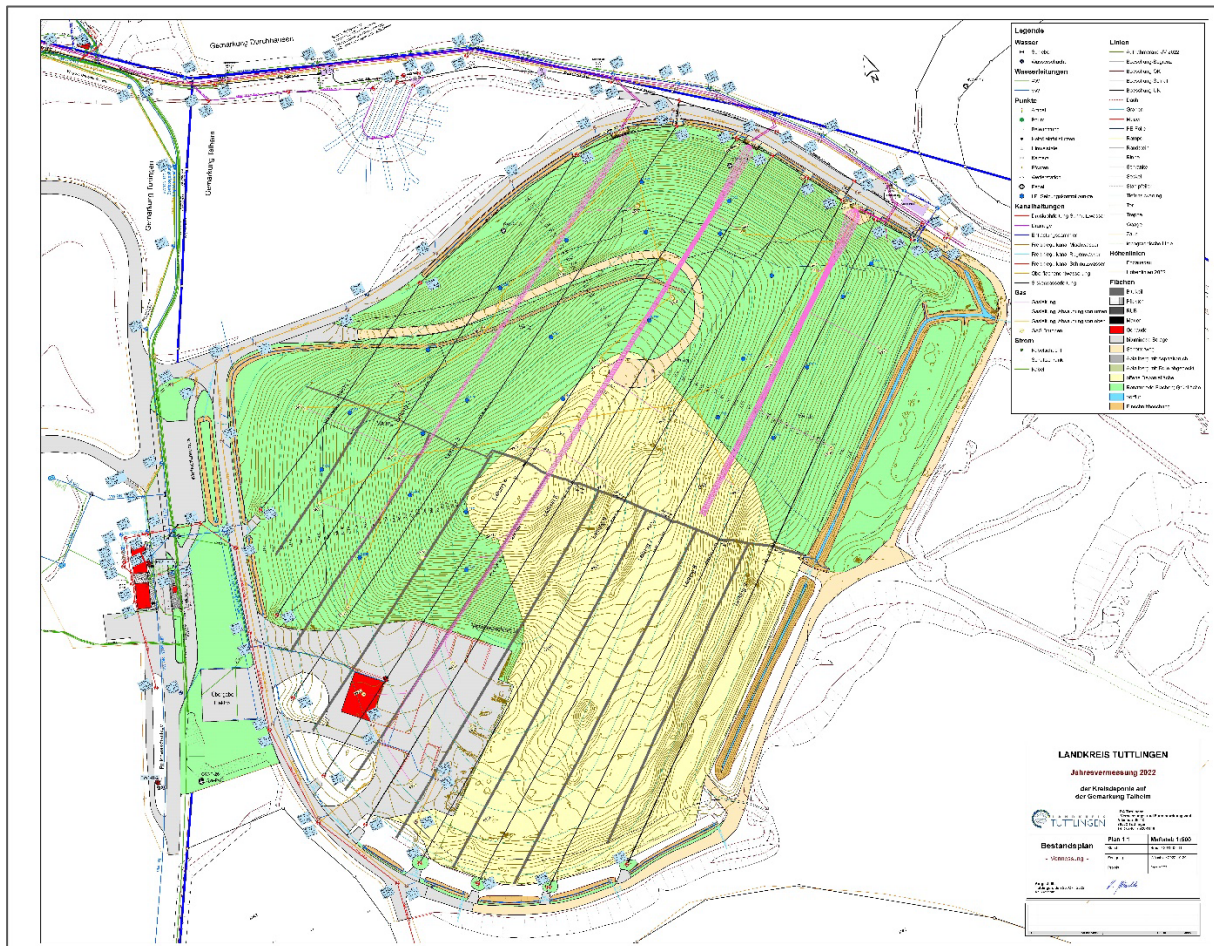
Bestandslageplan Jahresvermessung 2022 - Deponie Talheim
